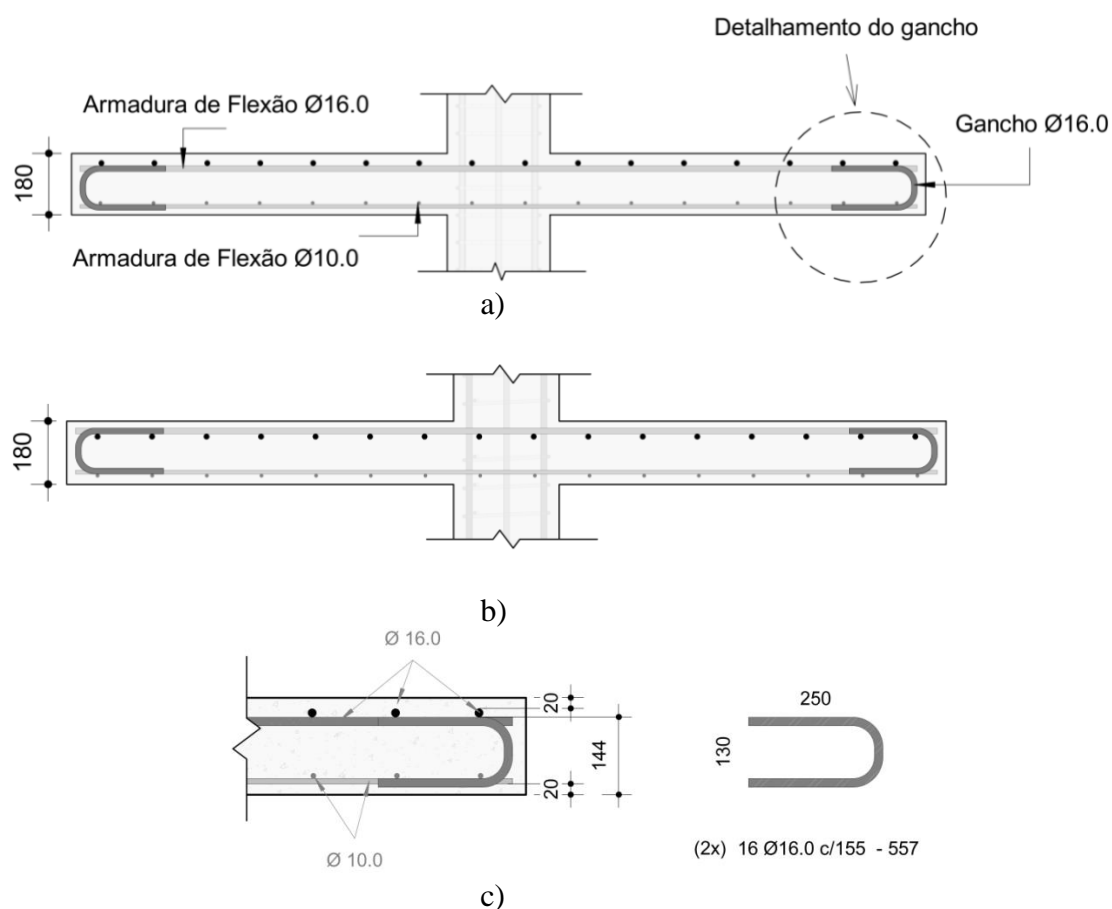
a) Representação do corte AA da armadura de flexão; b) Representação do corte BB das armaduras de flexão; c) Representação do detalhamento dos ganchos da armadura de flexão.
